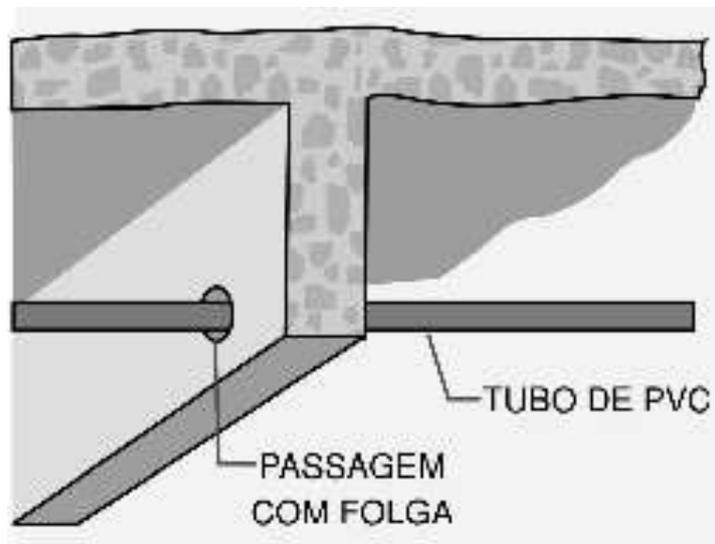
Passagem da tubulação em vigas, lajes ou paredes
